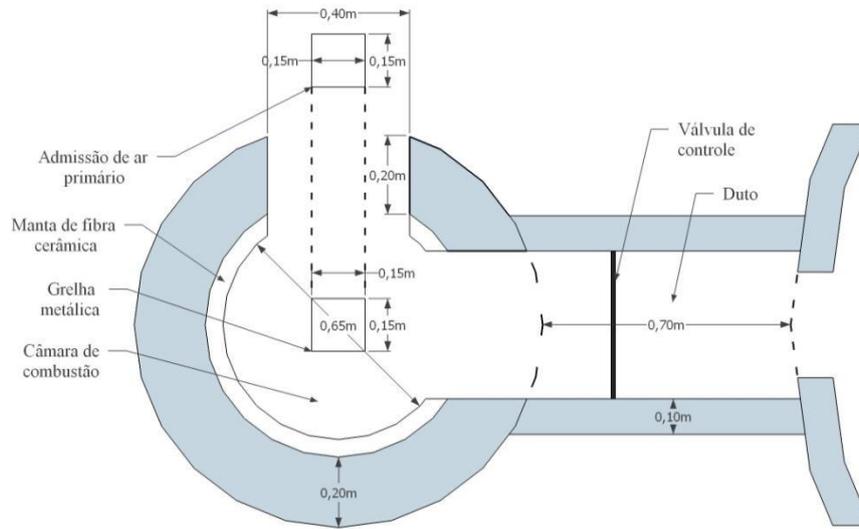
PLANTA BAIXA DA CÂMARA DE COMBUSTÃO E DUTO
